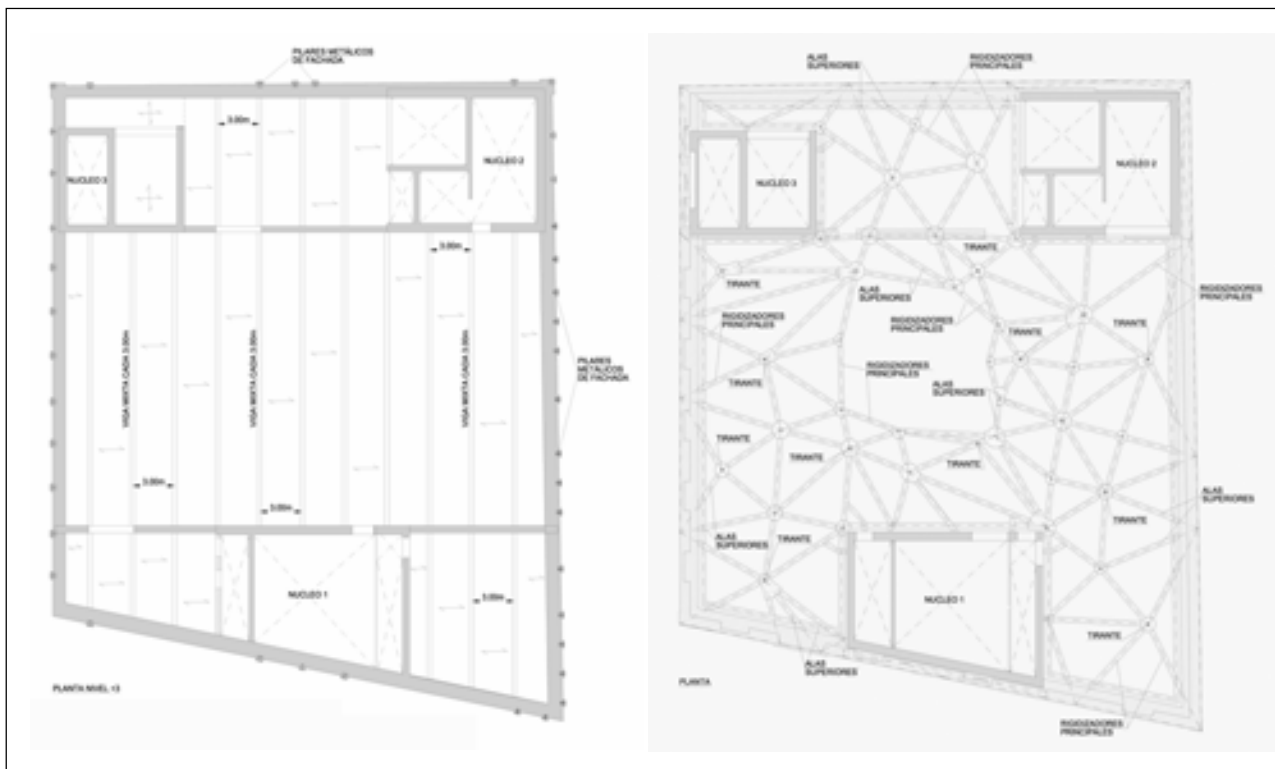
Planta tipo forjados mixtos superiores y planta forjado nivel 1.
